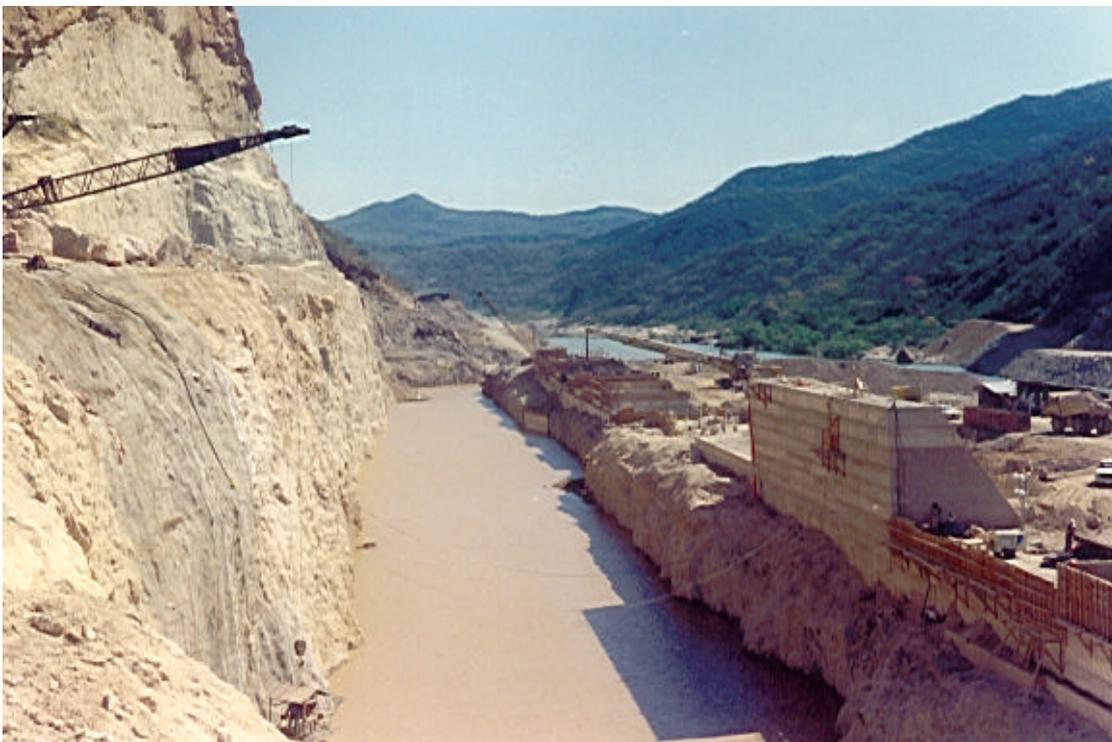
Creter Crane para a colocação de concreto-HUITES-MÉXICO.
